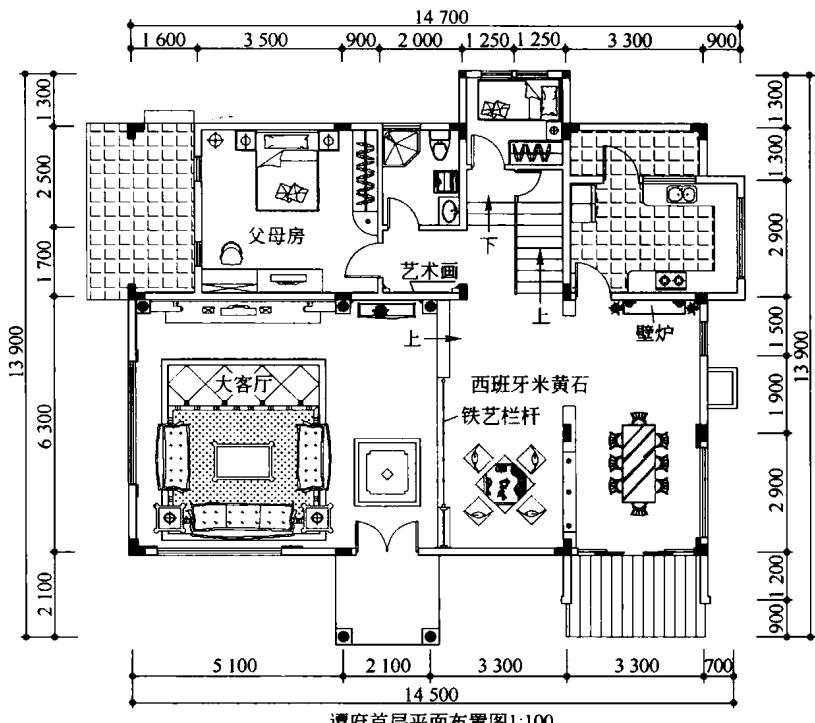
别墅设计首层平面图（文健、石树勇 设计）
